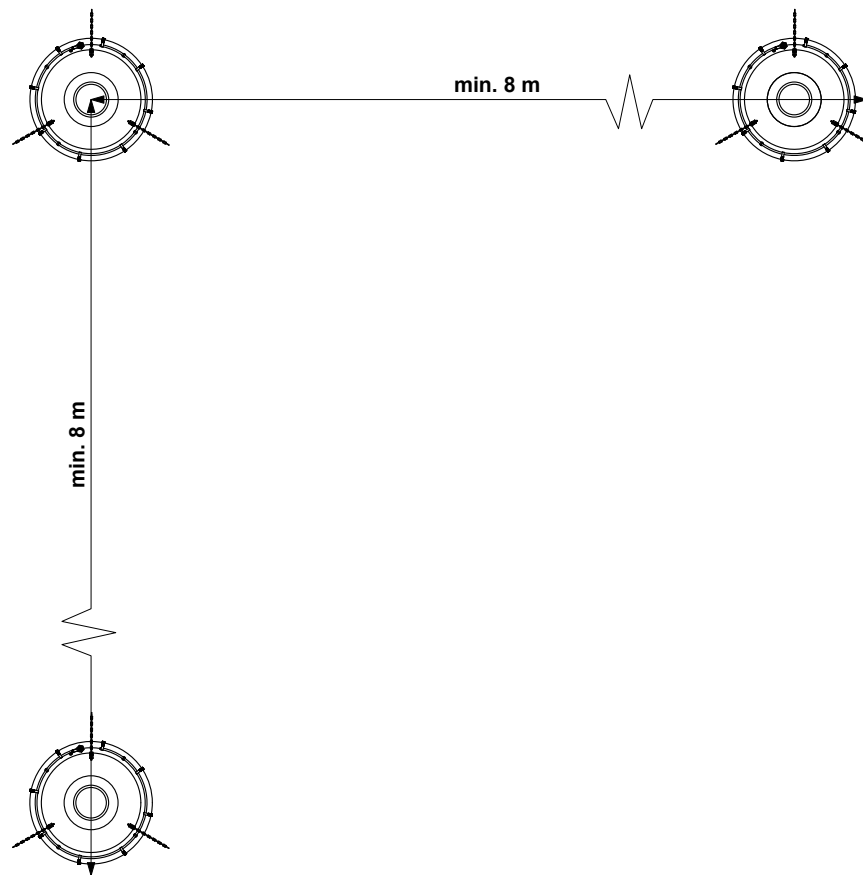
Min. Abstand zwischen Condair Vita Space Verneblern
